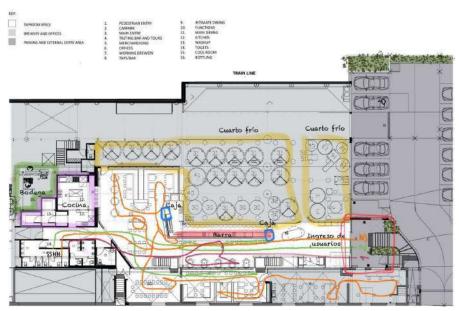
Planta arquitectónica de Taproom - Recorrido y experiencia Fuente: ArchDaily
